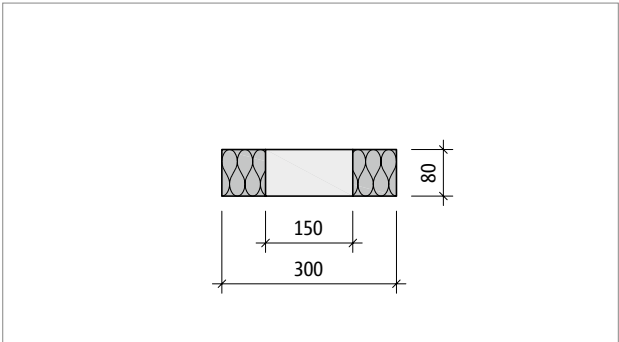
Schöck Sconnex® type W-N : coupe du produit
